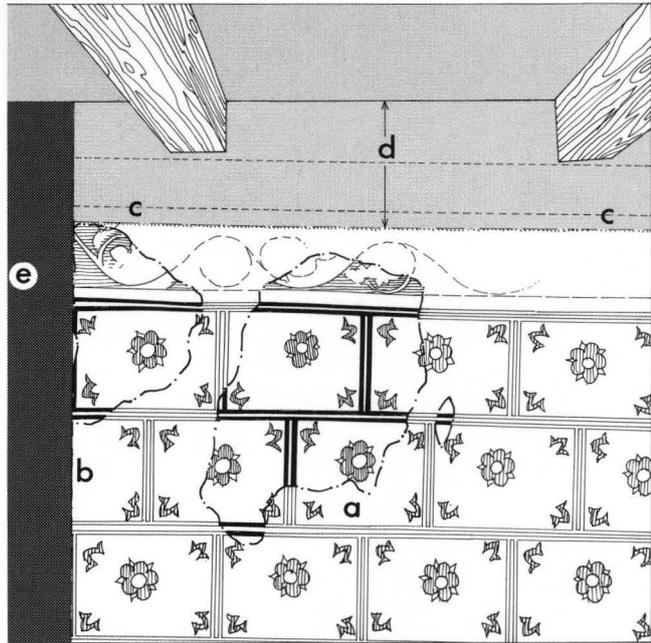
Malereifund an der Südwand unter dem Dach. Rekonstruktionsplan mit Bauphasen. – Zeichnung: St. Tramèr.
